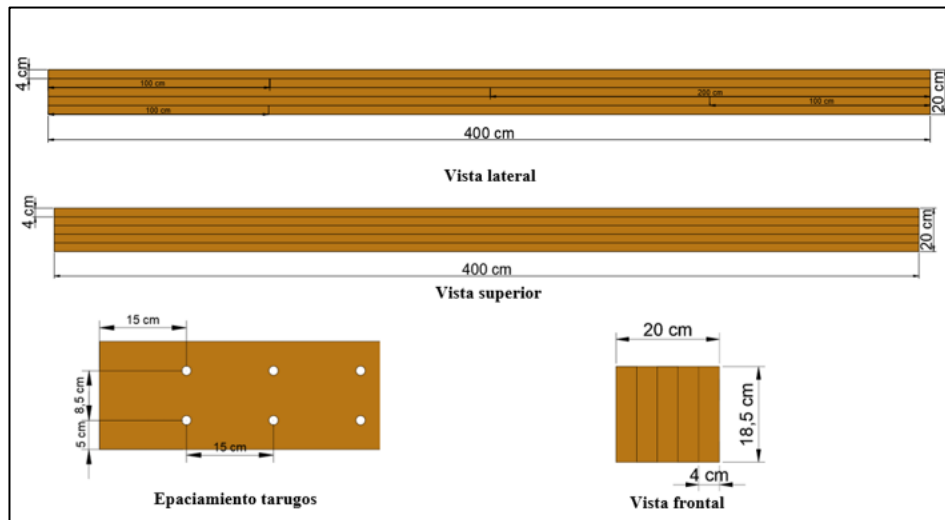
Vistas con detalles viga de laminación con empalme a ensayar
